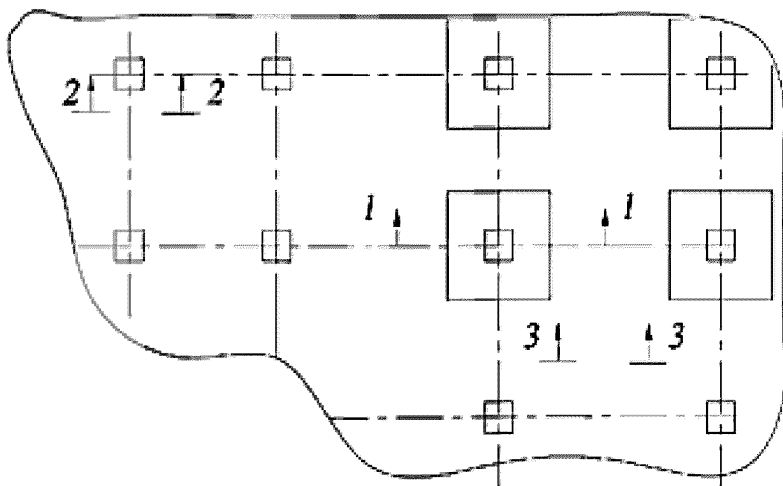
Фрагмент плана сплошного фундамента
